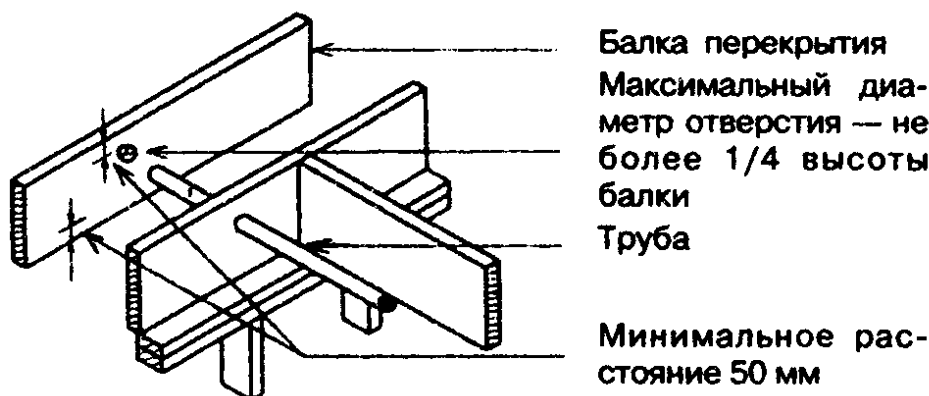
Размещение отверстия для пропускa труб и электропроводки в балках перекрытия
